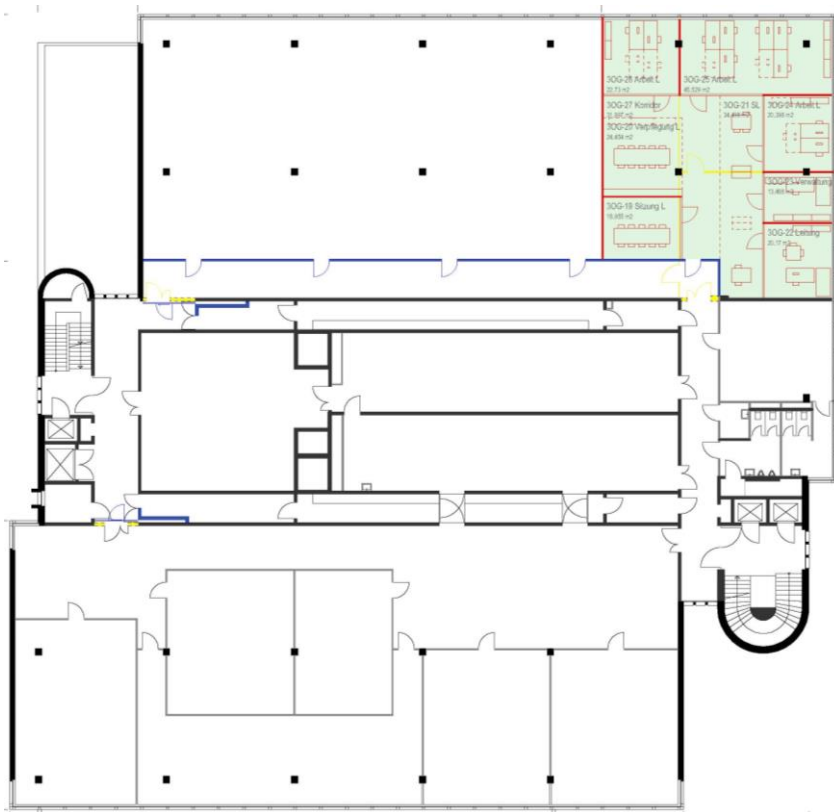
Grundriss Schule auf einem Geschoss, 3. OG, Lehrer- und Administrationsbereich
